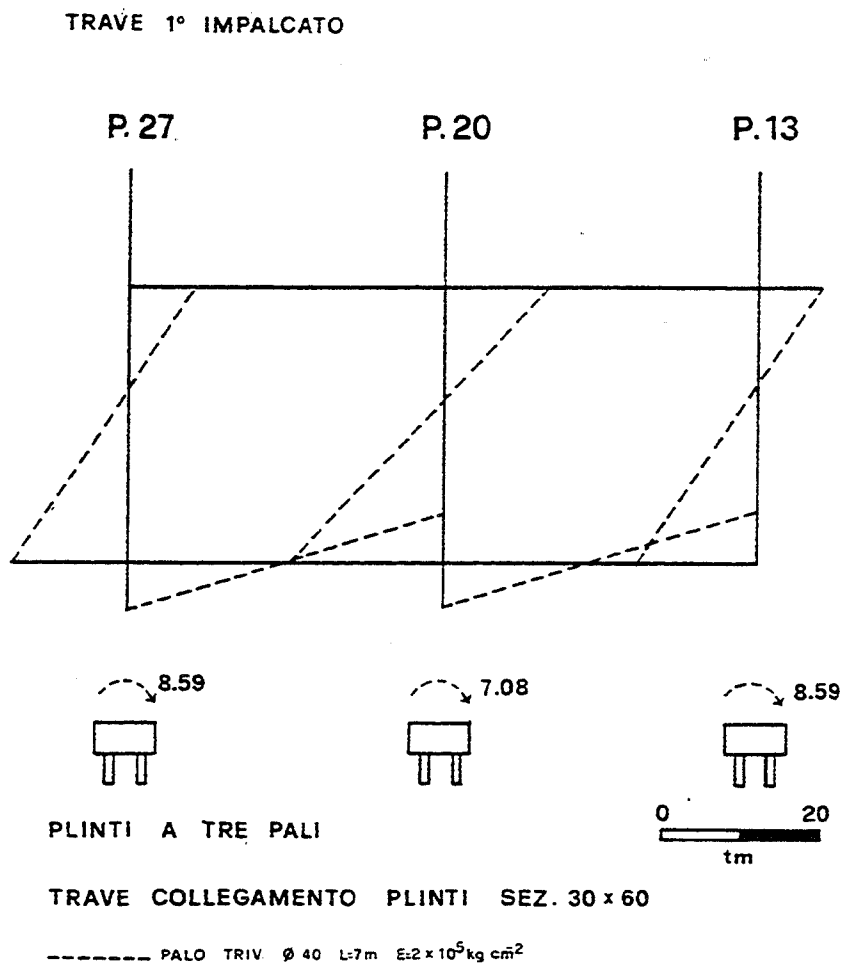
Analisi dell'interazione tra telaio, plinti e travi di collegamento.
